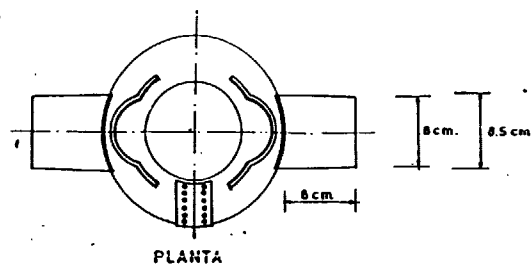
MOLDE PARA ENSAYO DE ASENTAMIENTO
